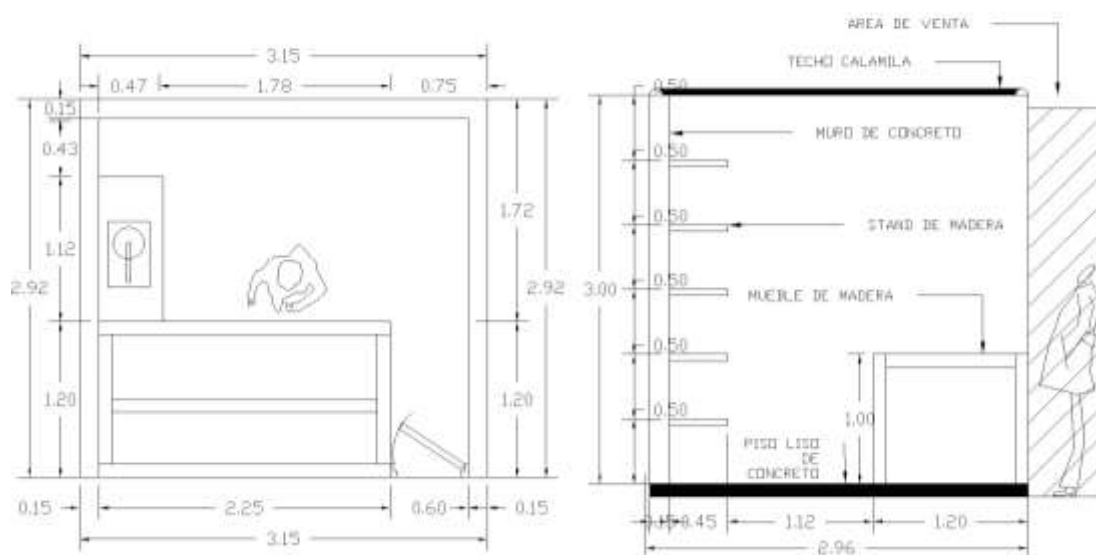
Corte Detallado y Planta del P. Verdura / Elaboración propia
